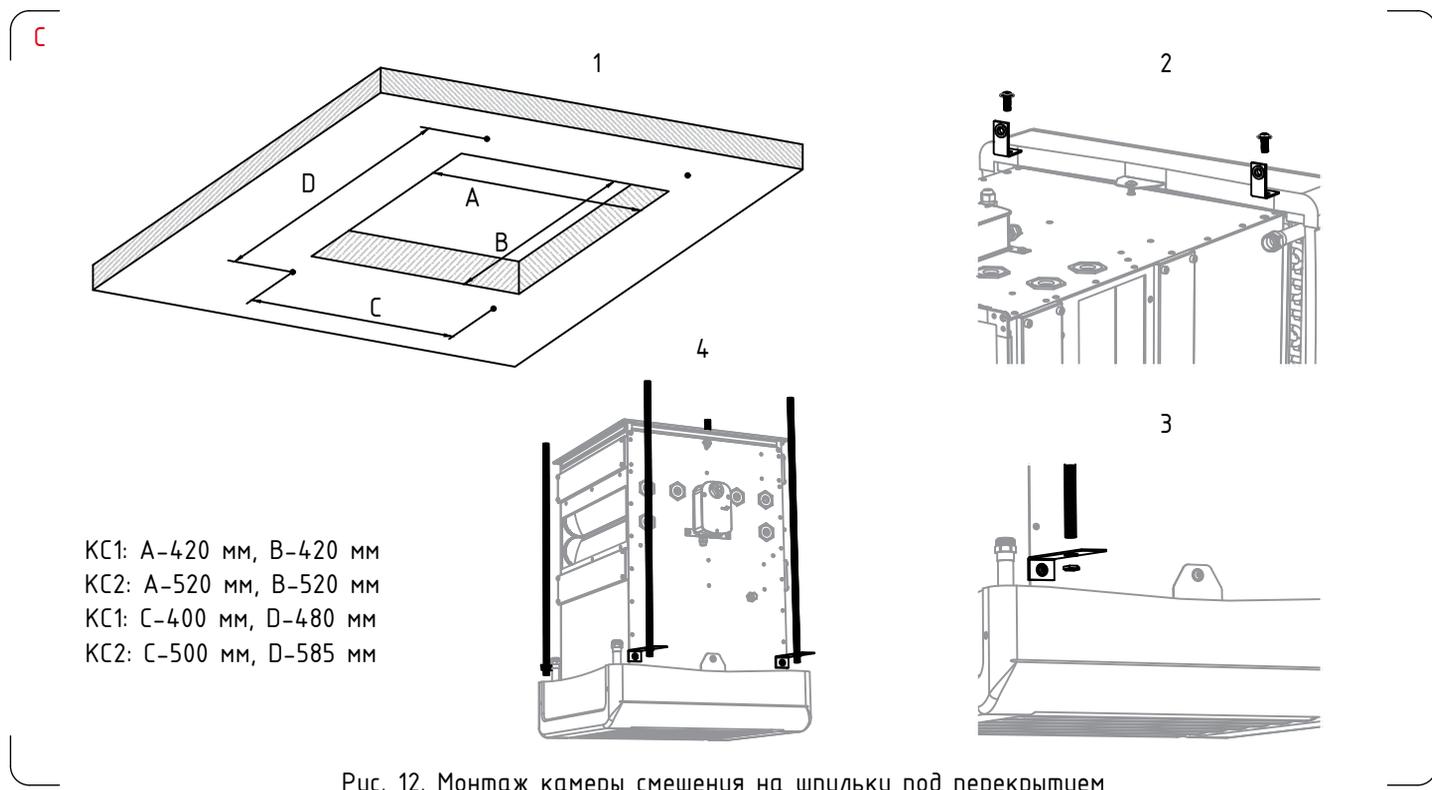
Монтаж камеры смешения на шпильки под перекрытием
